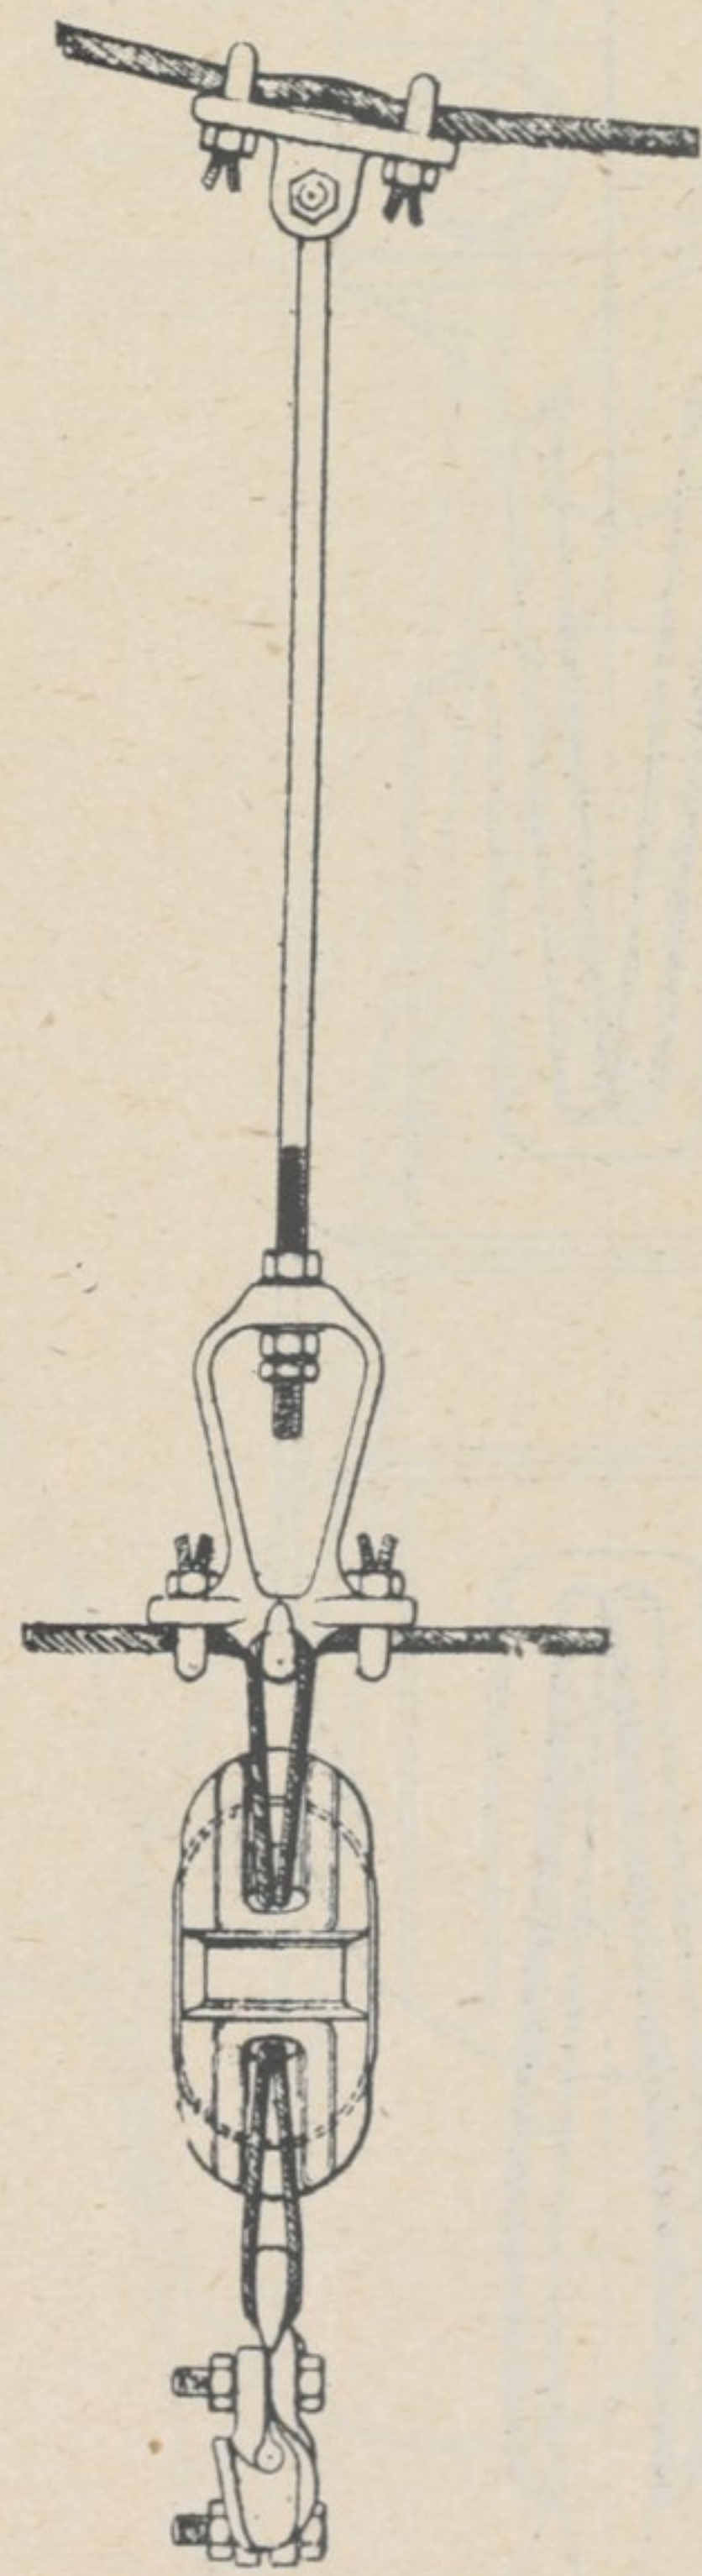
SECTIONNEMENT A LAME D'AIR.
